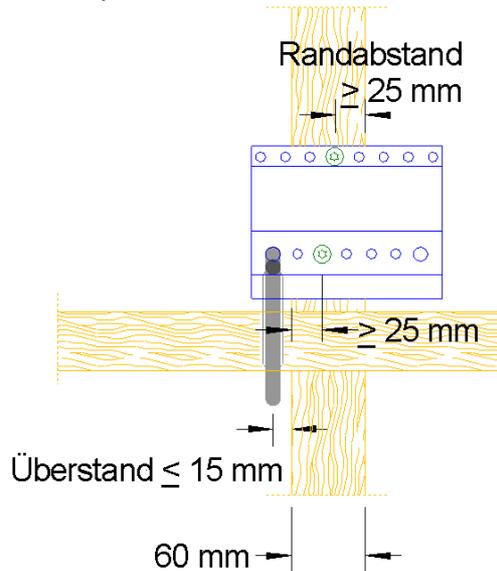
Grundprofilmontage – Detail: 6 cm Sparren
